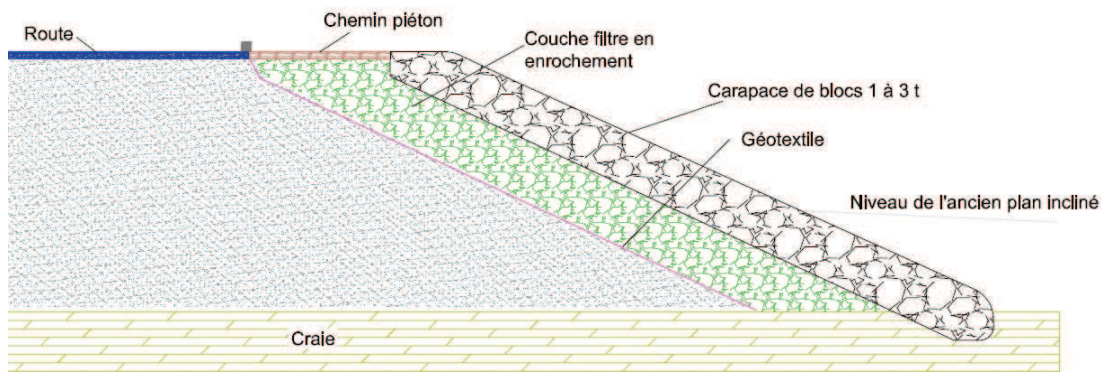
Coupe schématique sans échelle de la protection du talus en enrochements en partie Sud du brise-lame (Source : Antea group)
